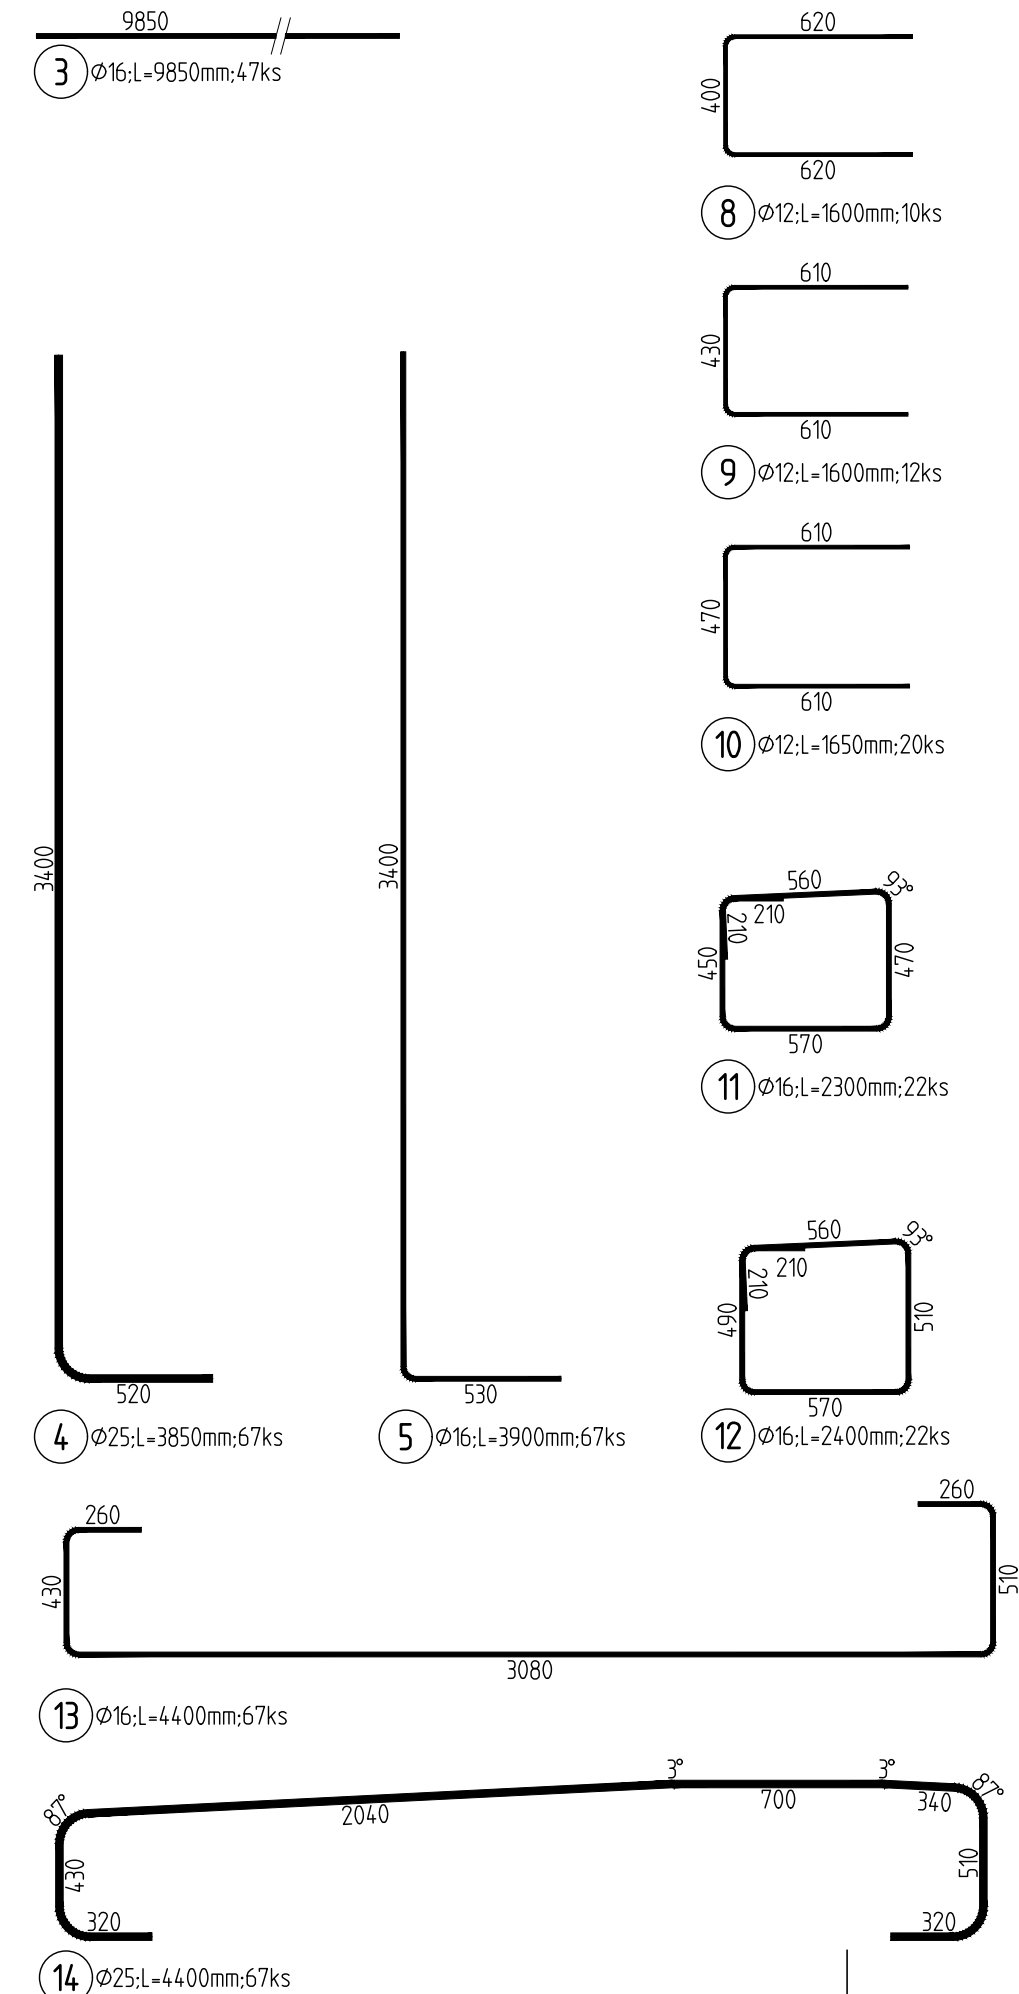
DETAIL DOPLNĚNÍ VÝZTUŽE V MÍSTĚ
